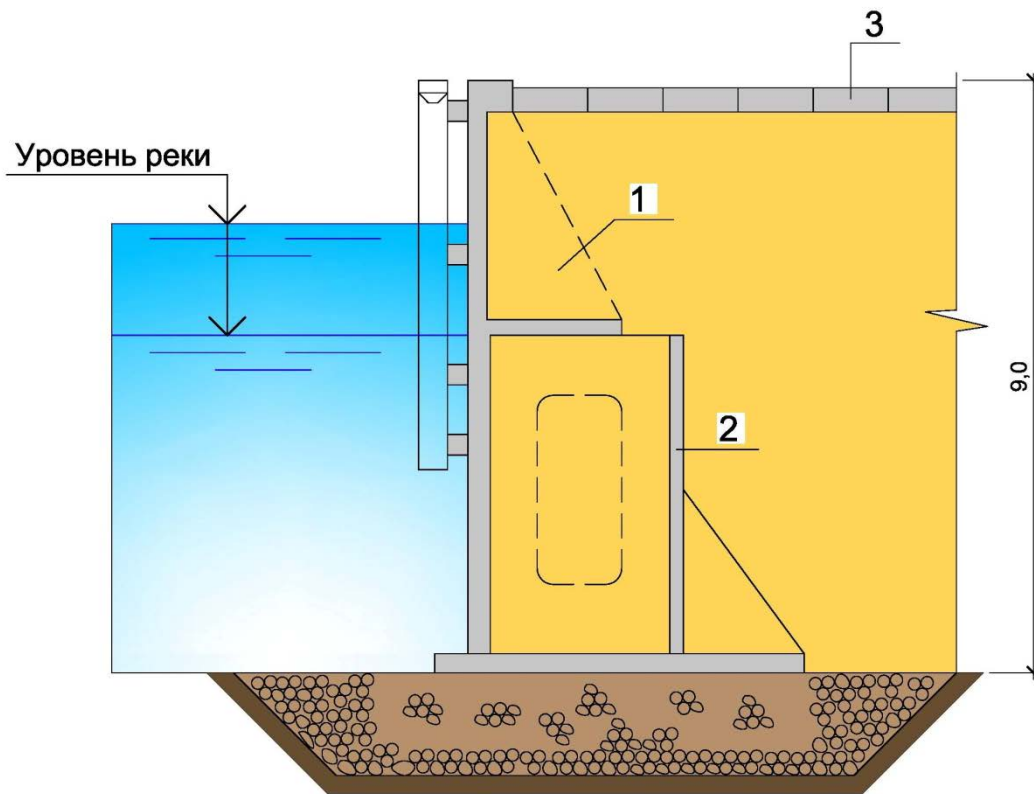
Конструкция причального сооружения из железобетонных массивов-гигантов:
